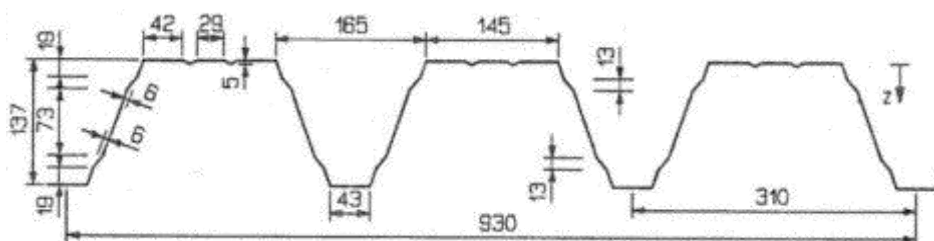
Lamiera trapezoidale in acciaio 137-310-930 in positivo.
